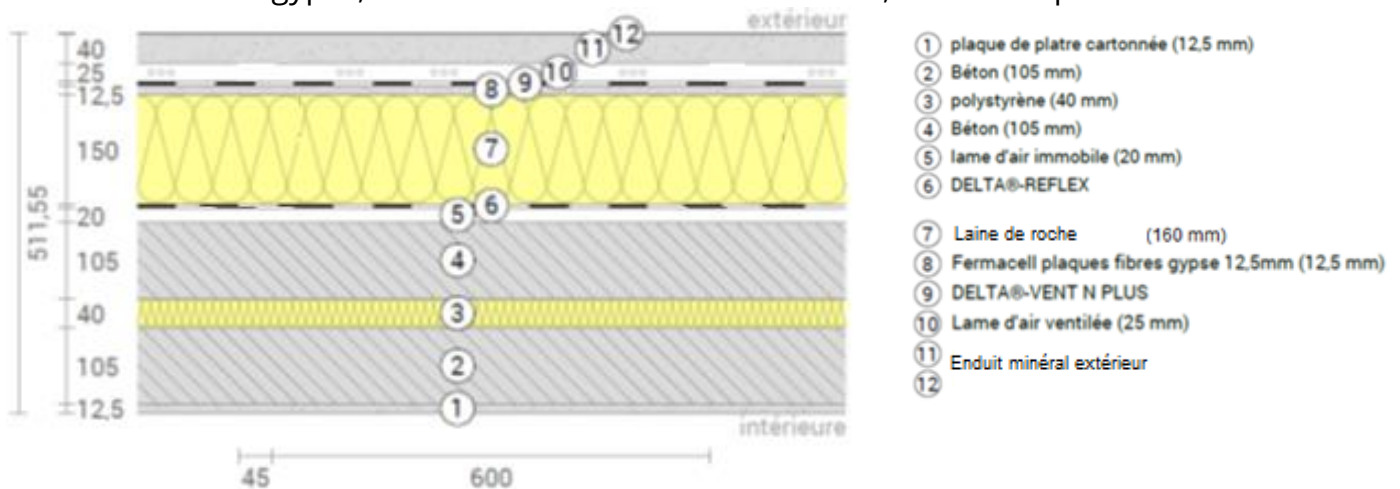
Plan en coupe du Modèle 4 proposé en ITE
